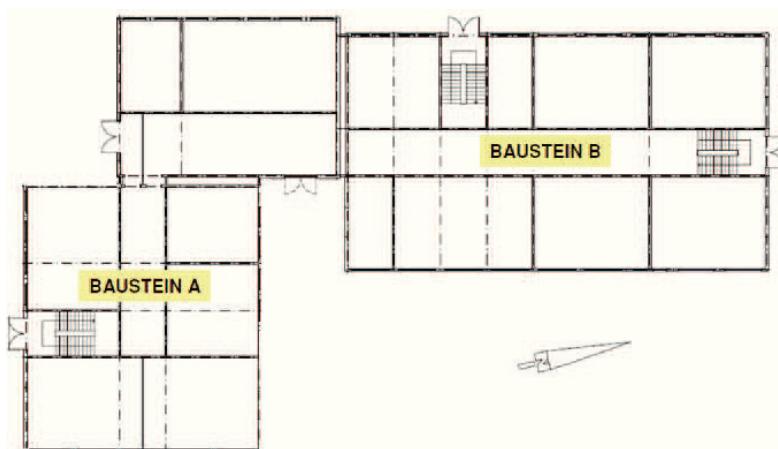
Grundriss des Gebäudekomplexes A und B
